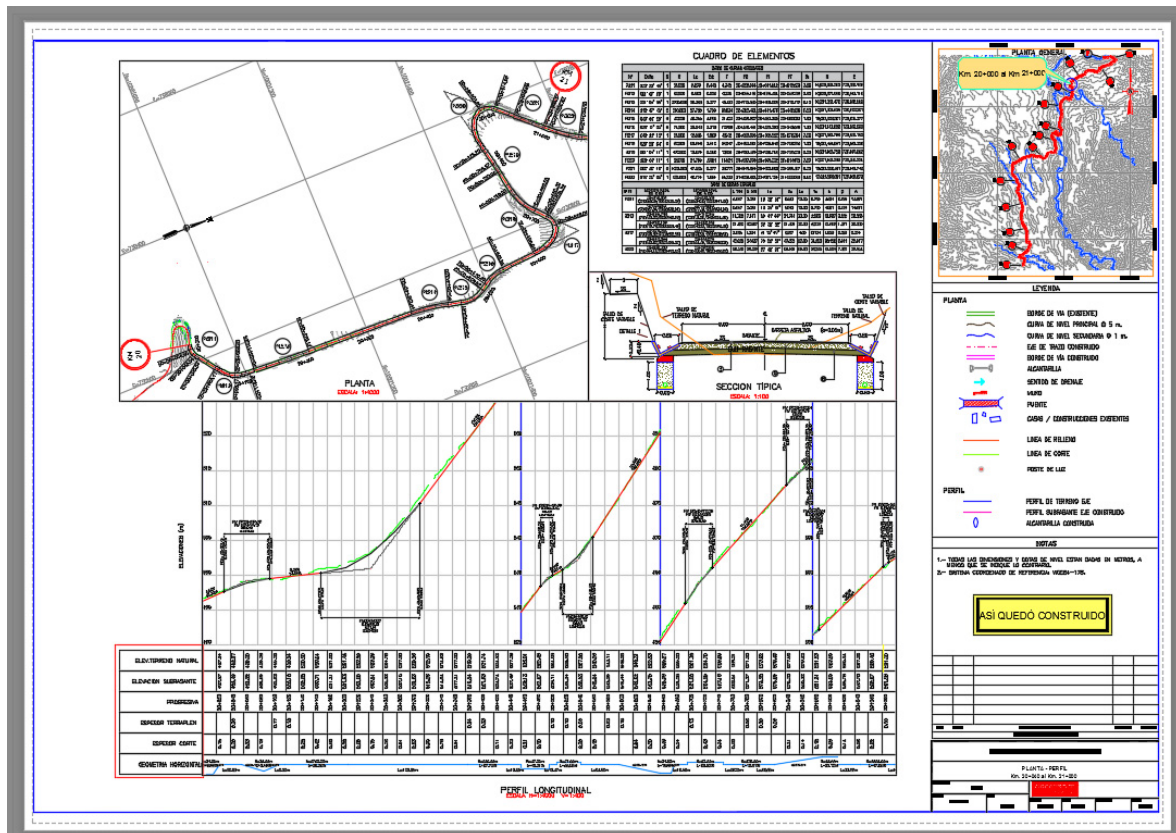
Presentación de Plano Planta - Perfil en formato de cajetín parametrizado. Fuente: Acuña Xavier
